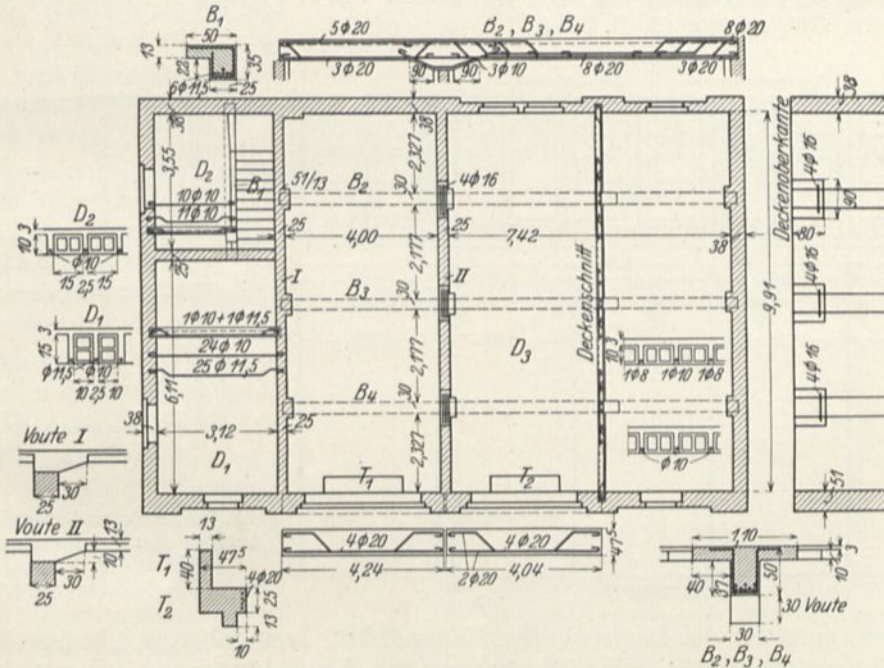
Garage und Wagenremise Cathrinhöfen. Ausbildung der Massivdecke des Erdgeschosses.
